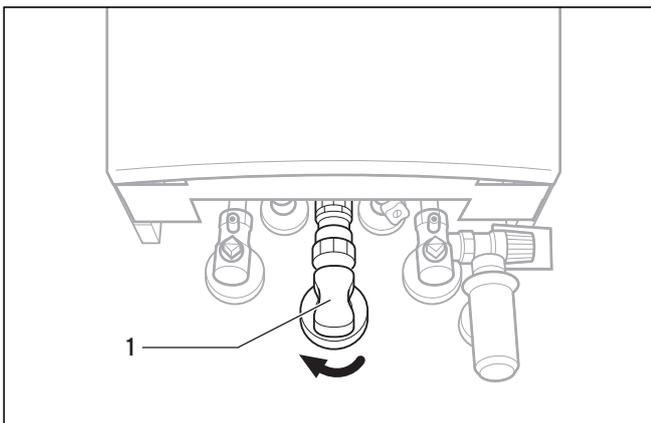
Gasabsperrhahn schließen (VC 146, VC 206 und VC 276); Beispiel: Unterputzinstallation
